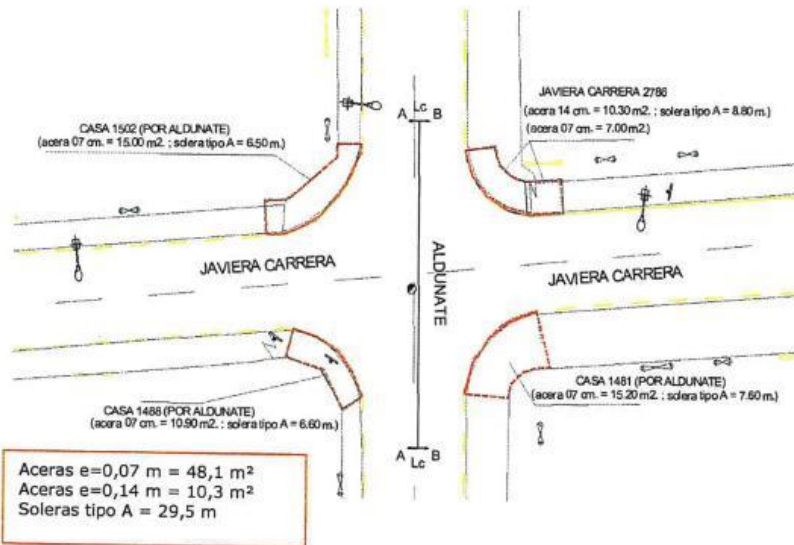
Aumentos de obra. Aceras de hormigón y soleras tipo A en calle Javiera Carrera con calle Aldunate.
